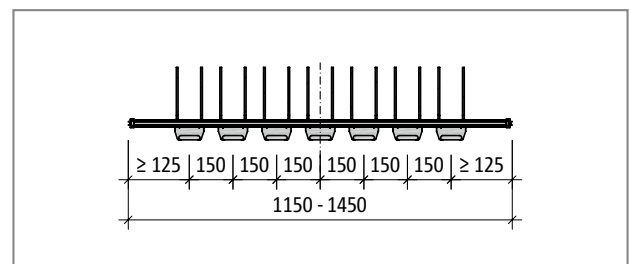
Schöck Tronsole® Typ T-V7-H...-L1150 bis L1450: Produktgrundriss
